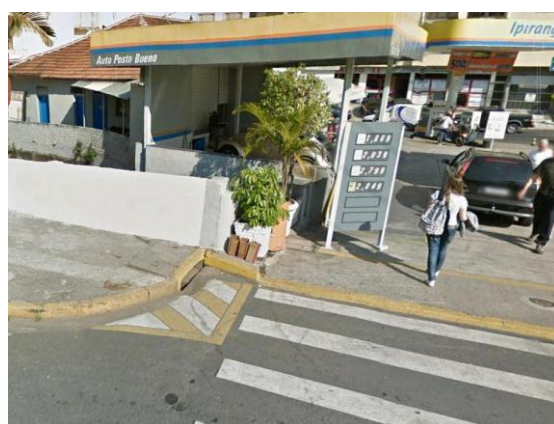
Boca de lobo subdimensionada e mal executada. (Fonte: Google Earth 2013)
